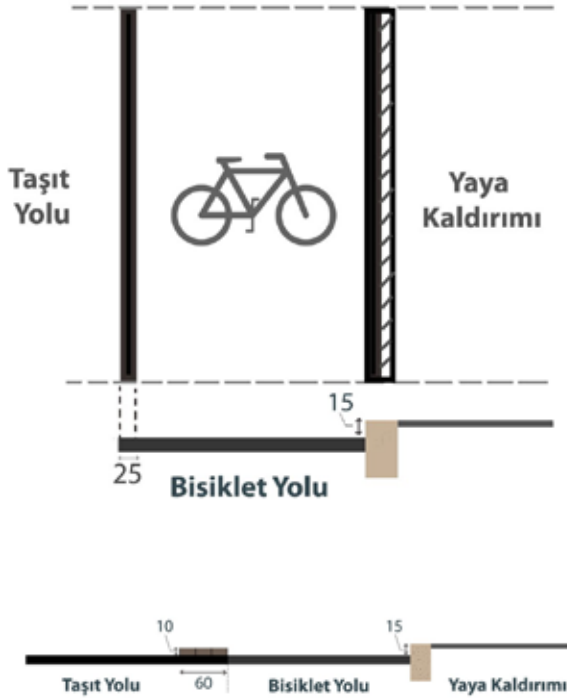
Murat Hüdaverdigar Caddesi plan-1, plan-2, plan-3
